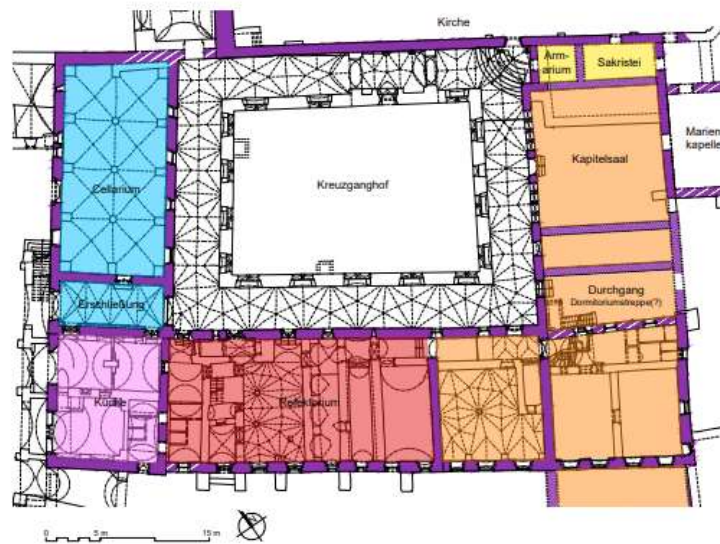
Grundriss des Klostergevierts mit Kennzeichnung der romanischen Mauerzüge und der Bauabschnitte:
